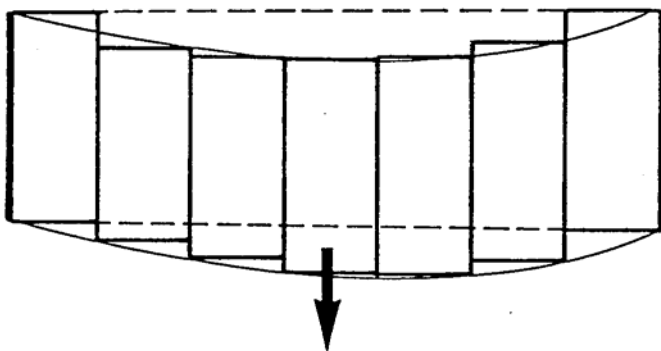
Des éléments préfabriqués disjoints n'offrent pas de raideur en plan.
